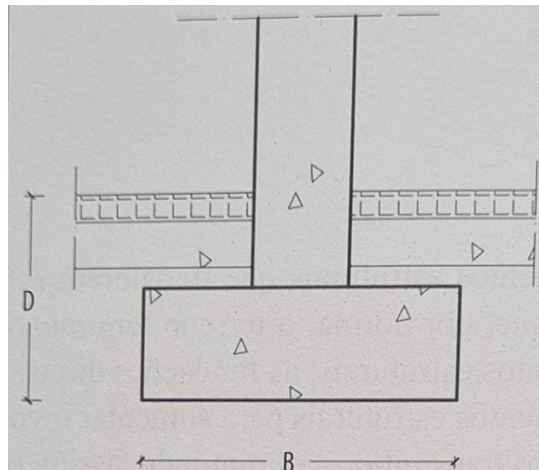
Fundações diretas: D - profundidade do plano da fundação, B - menor dimensão em planta ou diâmetro se a fundação for circular
